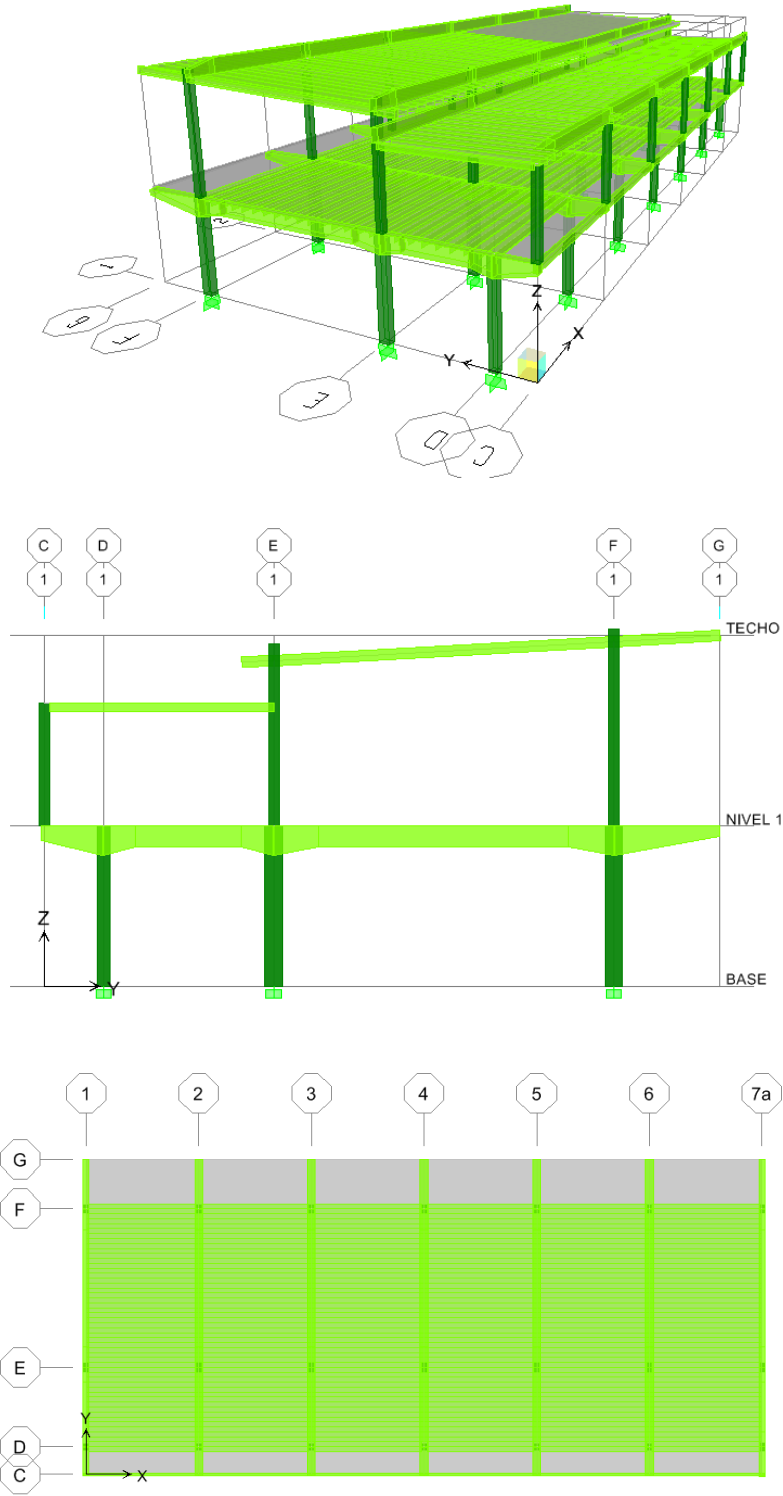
Imagen 3D, Corte y planta del Módulo 9
